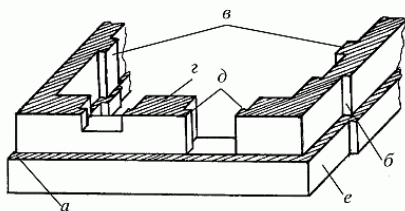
Детали каменных конструкций: а – обрез; б – уступ кладки; в – пилястры; г – простенок; д – четверть; е – цоколь
